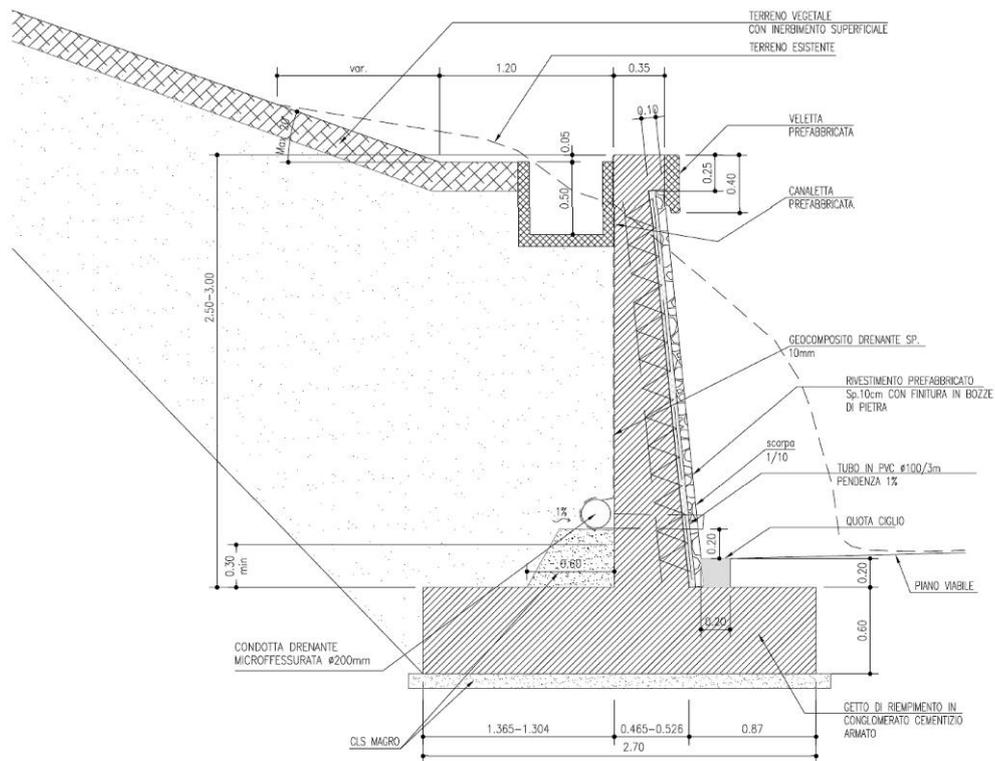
Sezione trasversale muro di controripa MC201 - H = 2.5/ 3m
